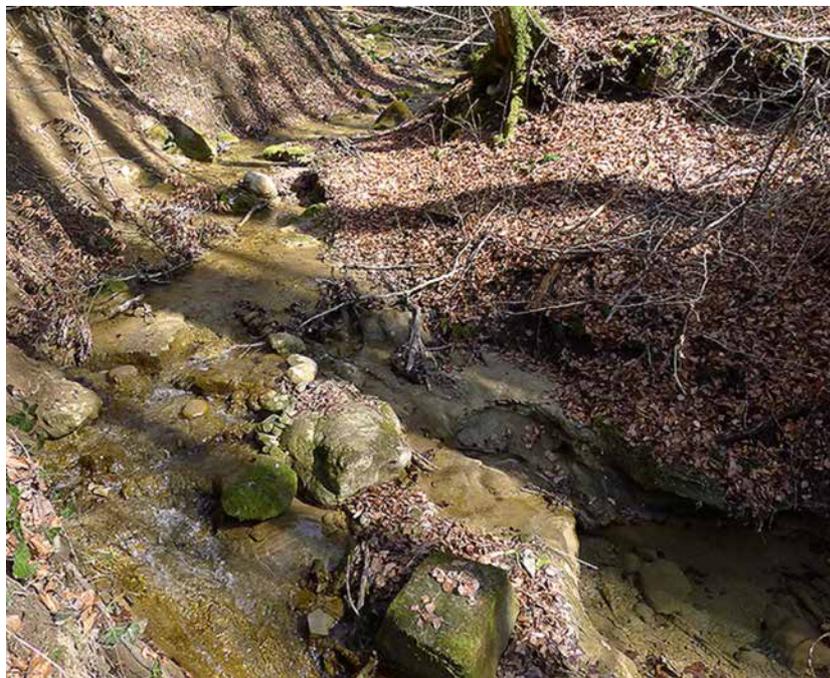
Zollbach vor Strasse nach Krummbach mit hinterfüllter Schwelle und anschliessendem Durchlass (22.3.2013).
